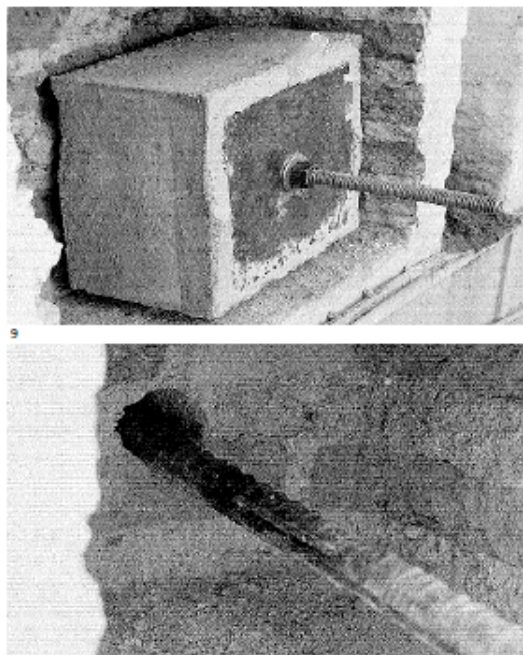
Perforaciones horizontales con barras de refuerzo interiores.
